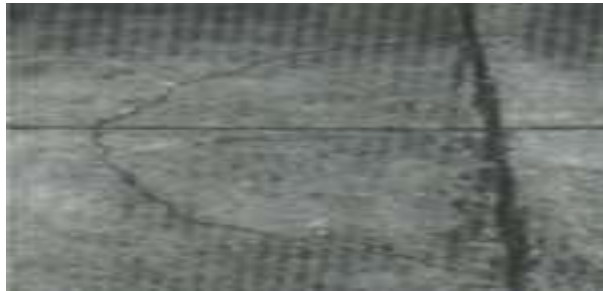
Grietas de Esquina de Baja Severidad.
